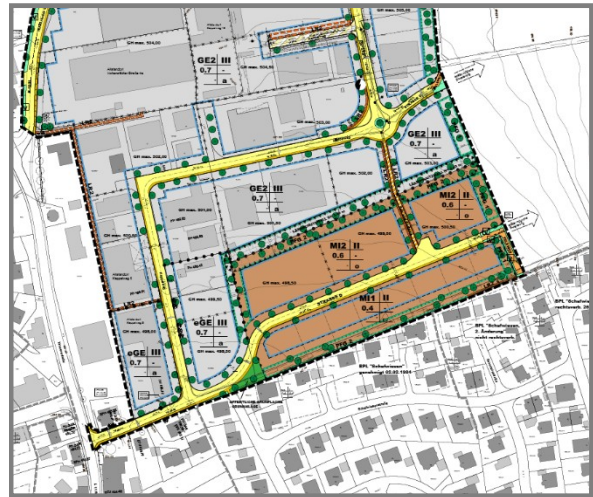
Ausschnitt rv. Bebauungsplan GE Kappelfeld
